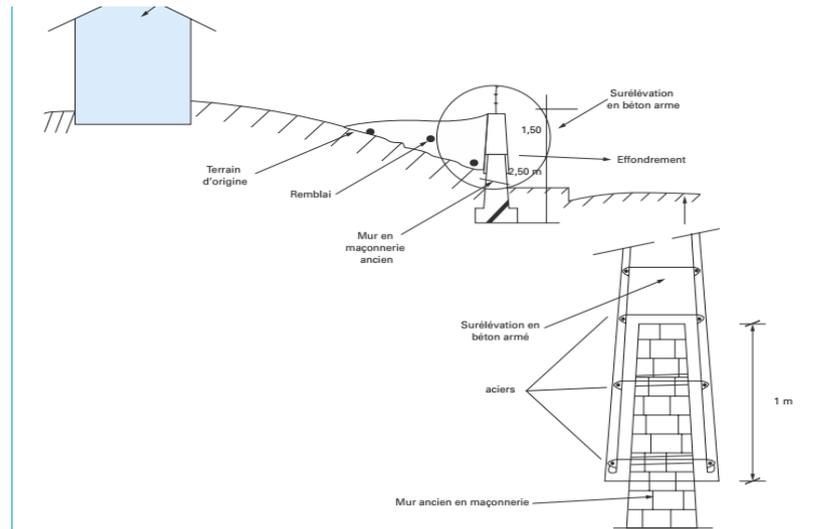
Mur de soutènement ancien surélevé sans étude.
